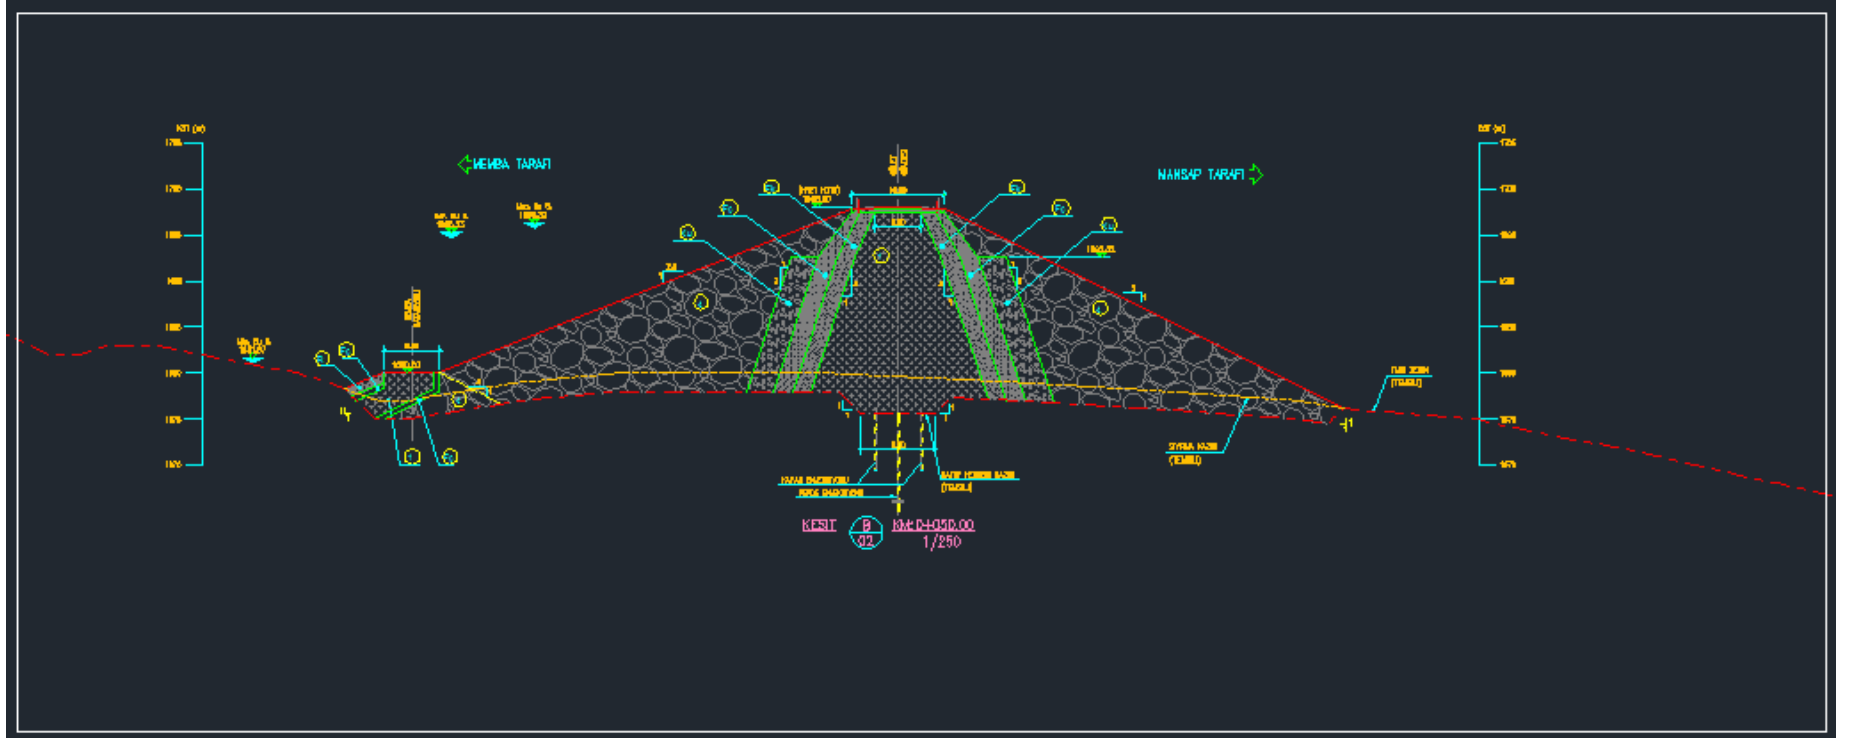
Gölet vaziyet planı (kil çekirdekli kaya dolgu)
